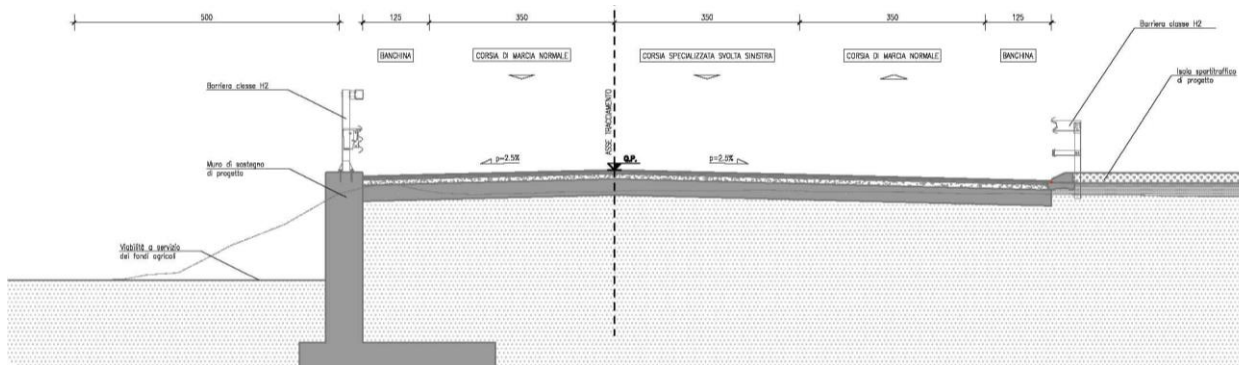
Sezione tipologica viabilità secondaria in rilevato con muro di sostegno
